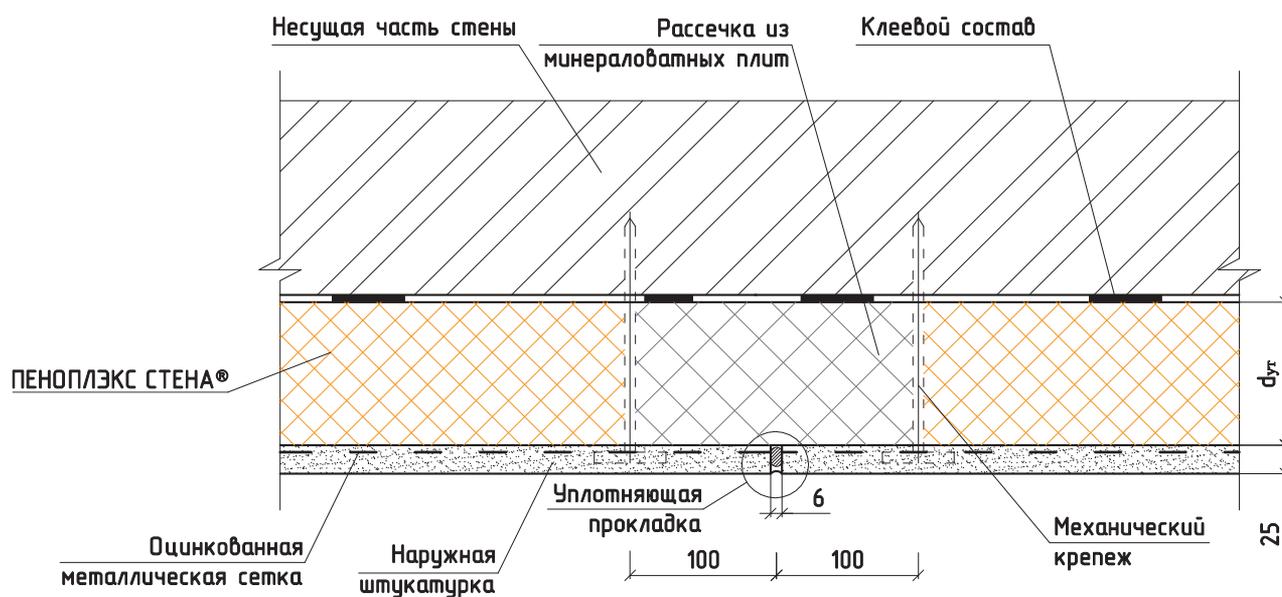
Разрез стены с вертикальной рассечкой из минераловатных плит
